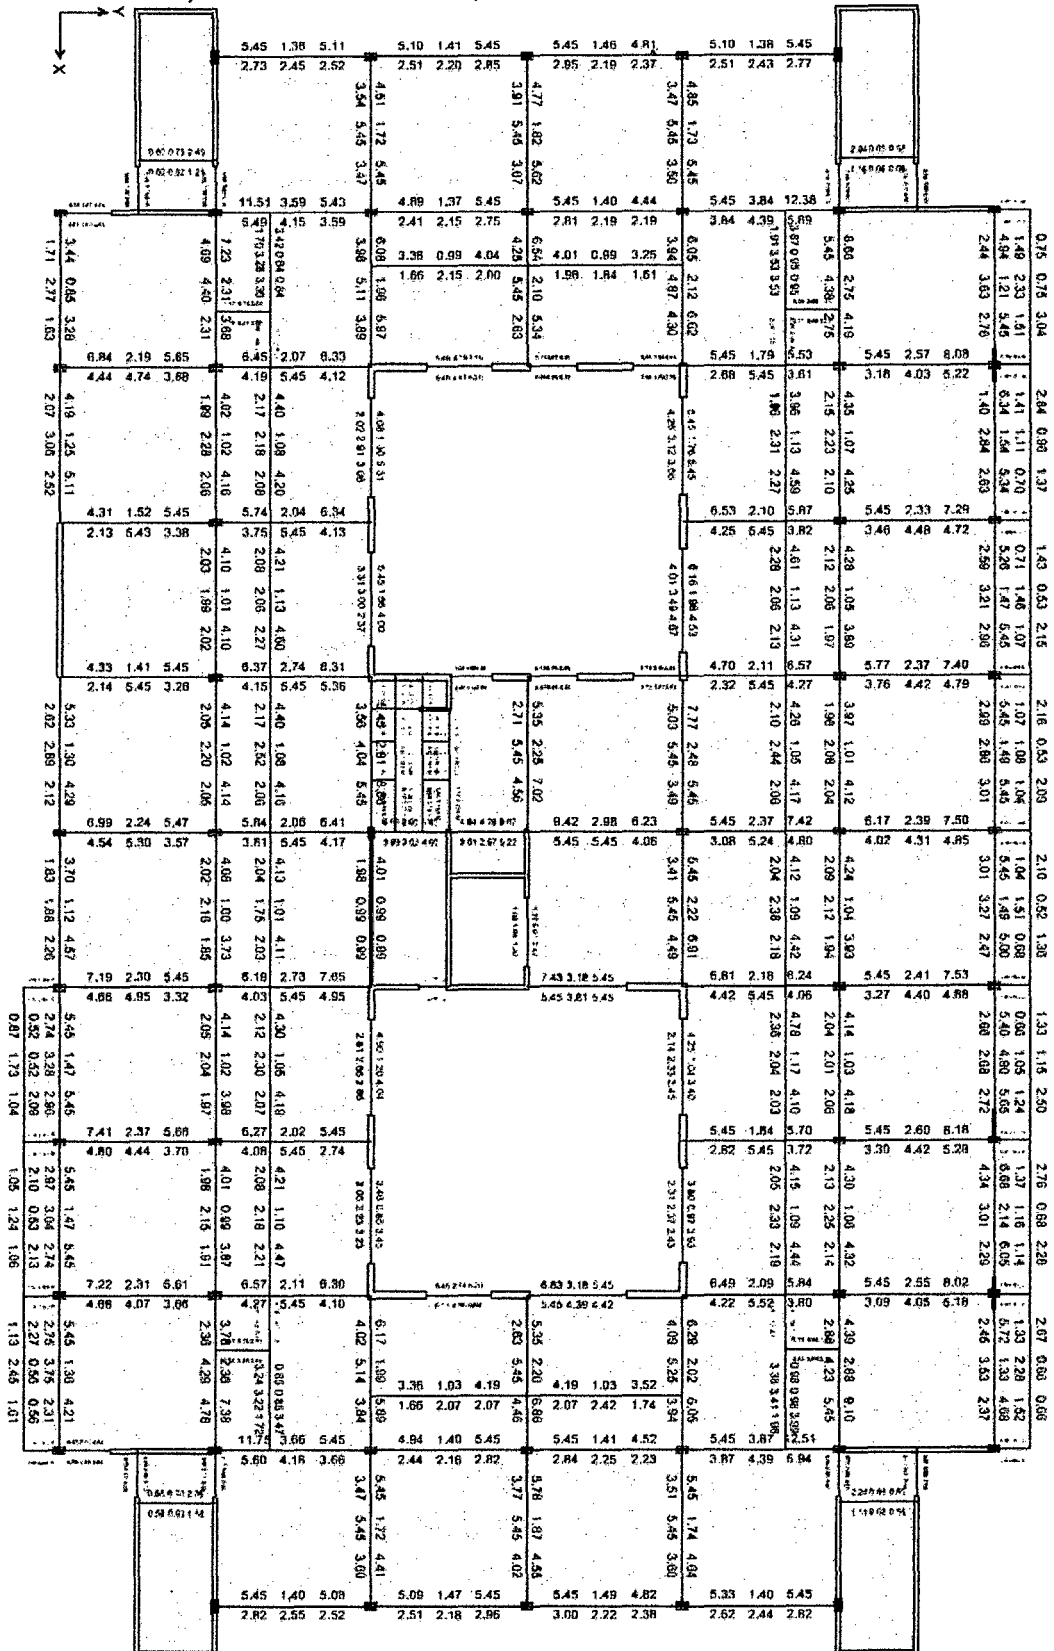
, Estructura convencional, Verificación de elementos estructurales - Piso 4.
